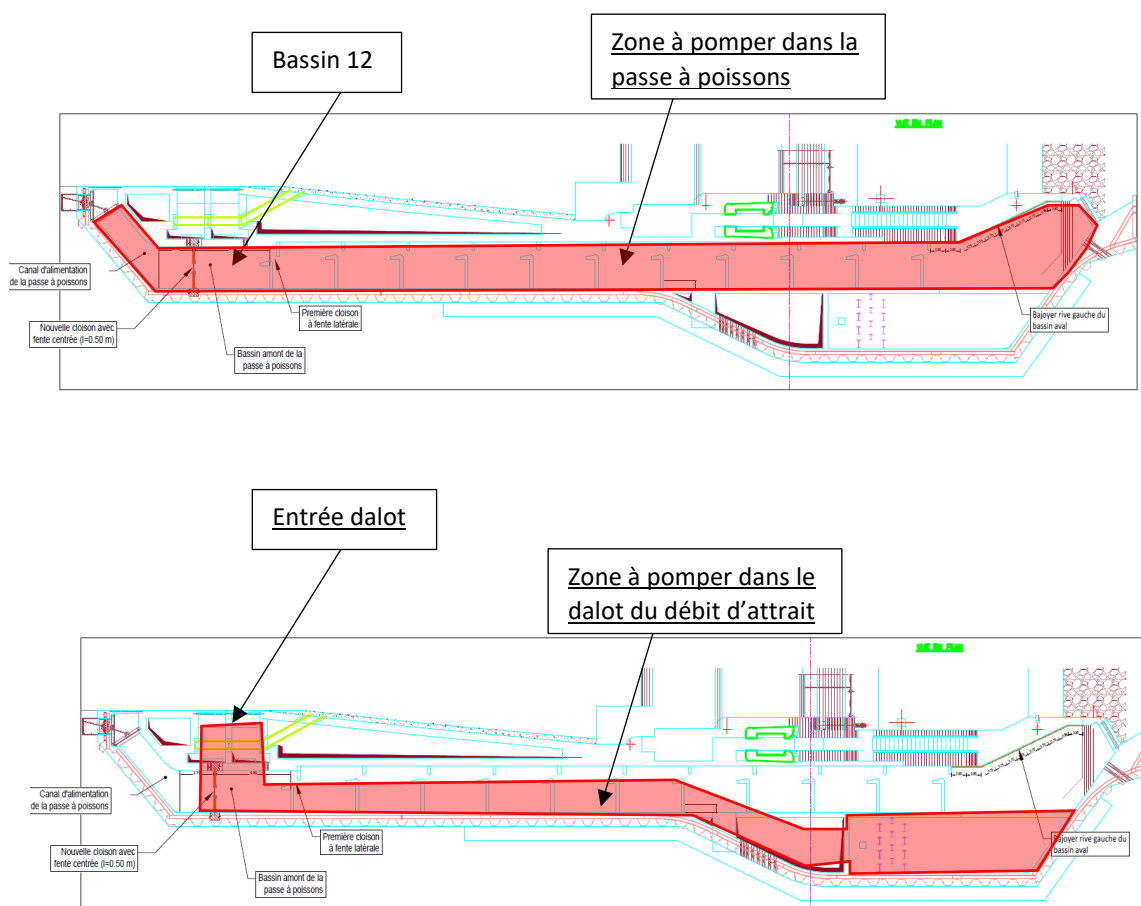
Zones à pomper pour la mise à sec du chantier – Passe à poissons + dalot débit d'attrait
